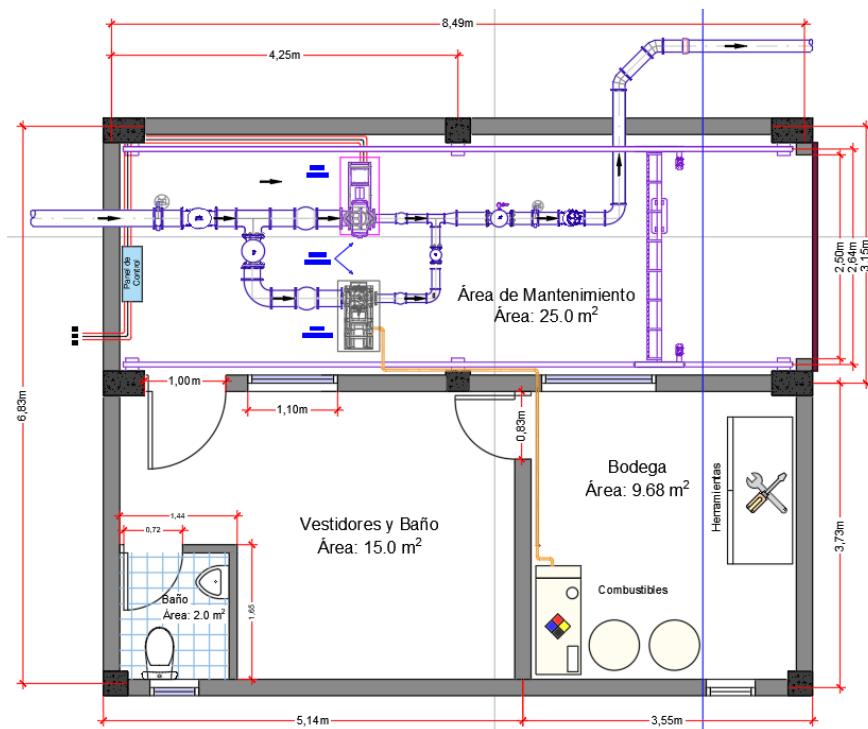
Plano arquitectónico de la distribución en casa de máquinas. Fuente: Autor.
